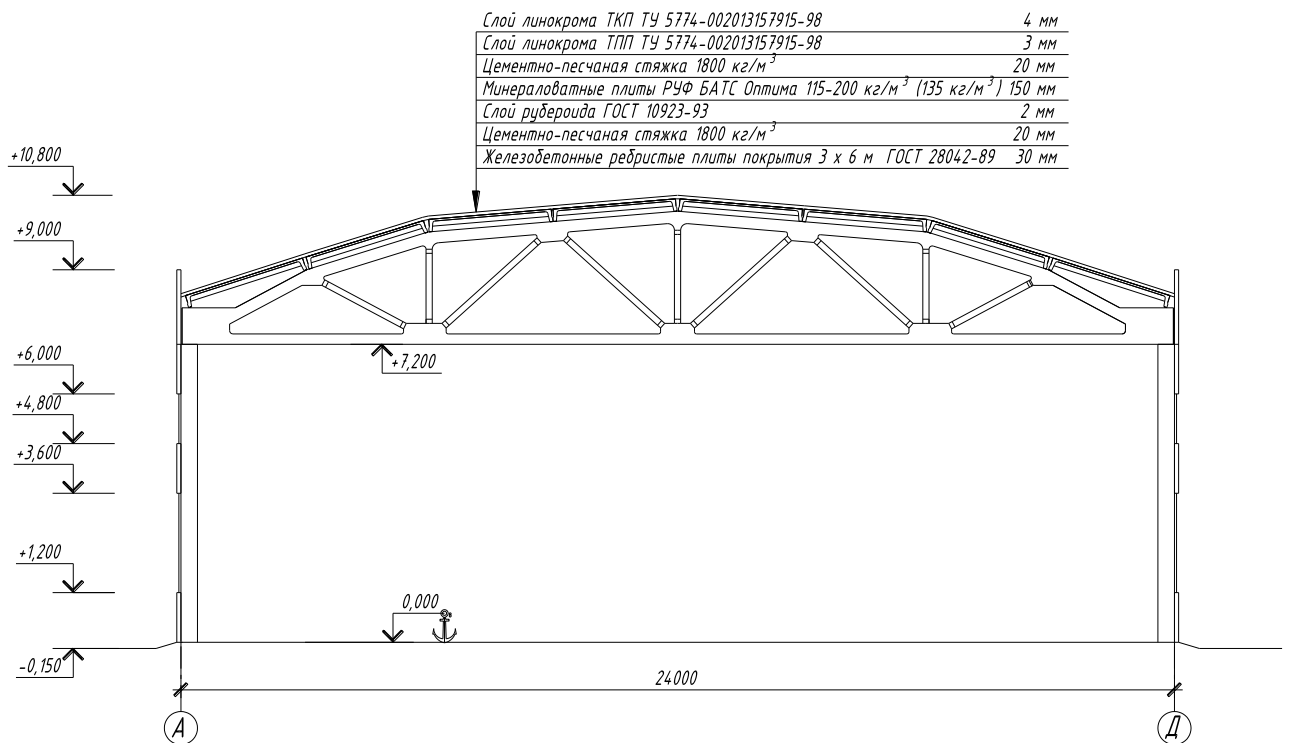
Вариант 1. Железобетонный каркас
